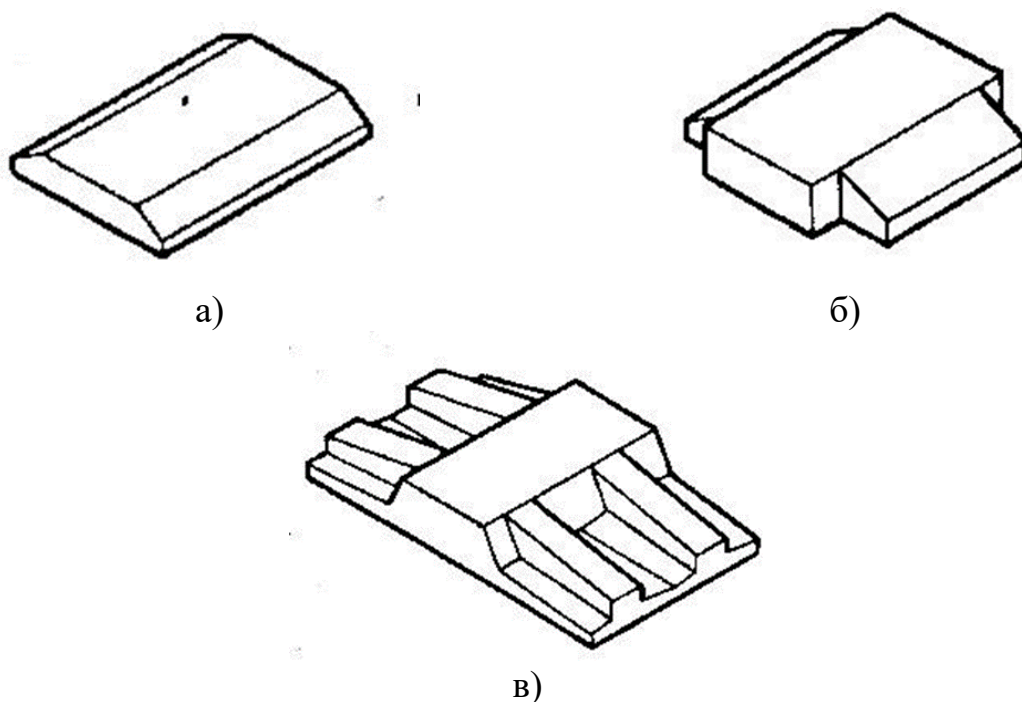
Конструкції фундаментних плит: а – суцільна; б – з кутовими вирізами; в – ребриста
